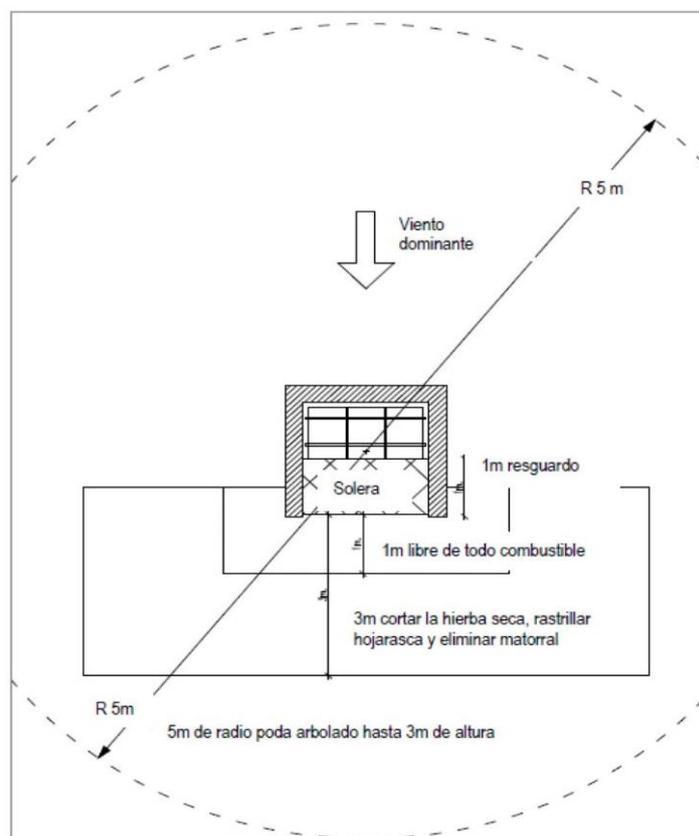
DETALLE ZONAS PRÓXIMAS A UN PAELLERO
